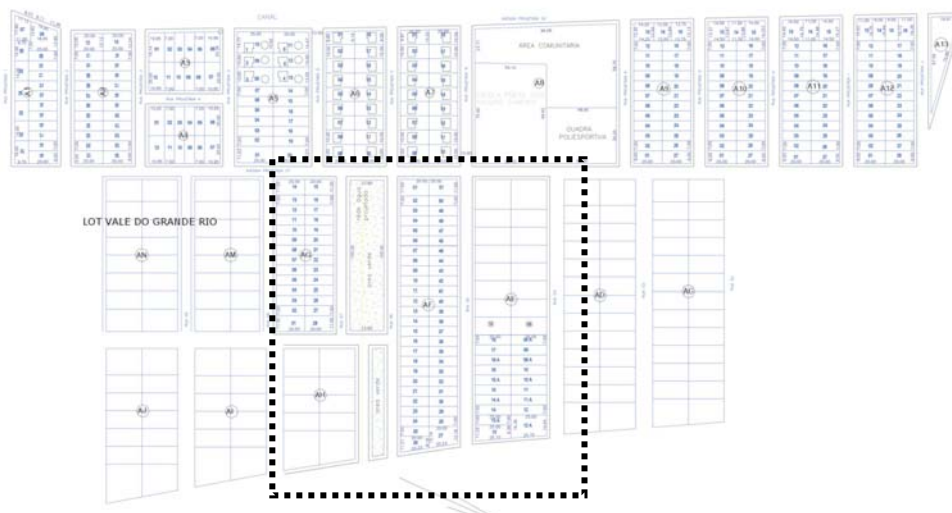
Planta do loteamento Vale do Grande Rio com lotes menores para construção de casas do PSH
